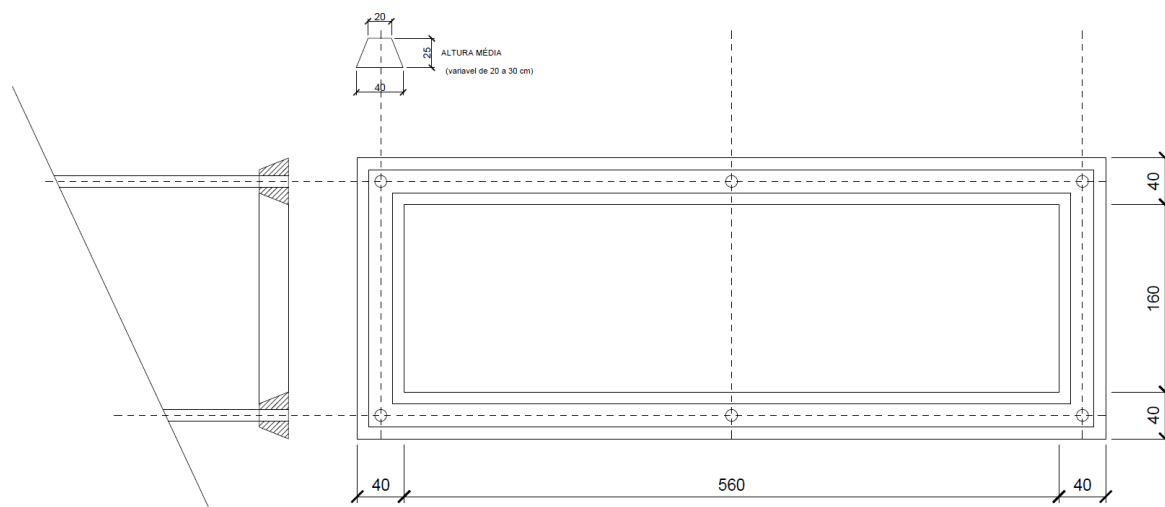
Fundação de concreto armado em formato de anel proposta para sustentação dos módulos FV nausina do Aterro Sanitário de Santa Cruz.
